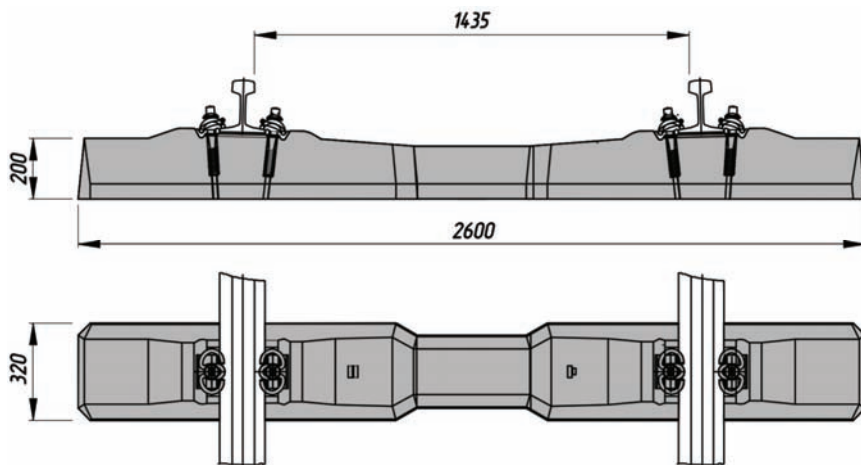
Niemiecki podkład strunobetonowy B70 2.3 w wersji dla przytwierdzenia W14 [17]
